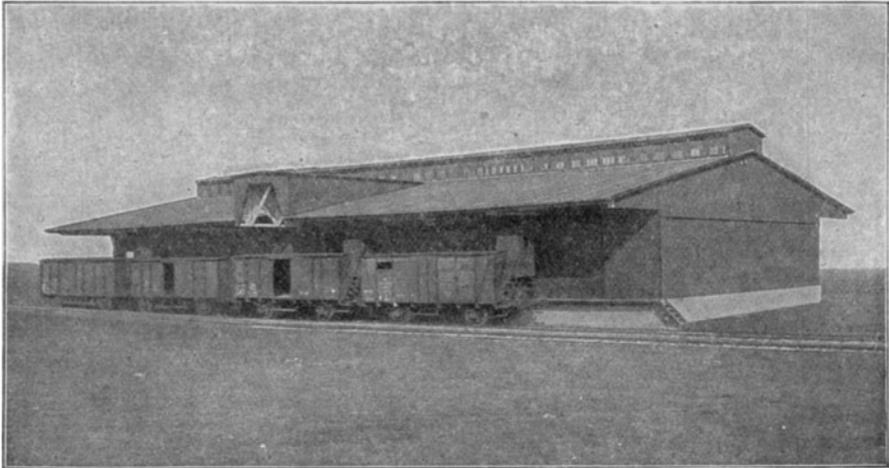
Ladehalle mit beiderseits überkragendem Dach.
